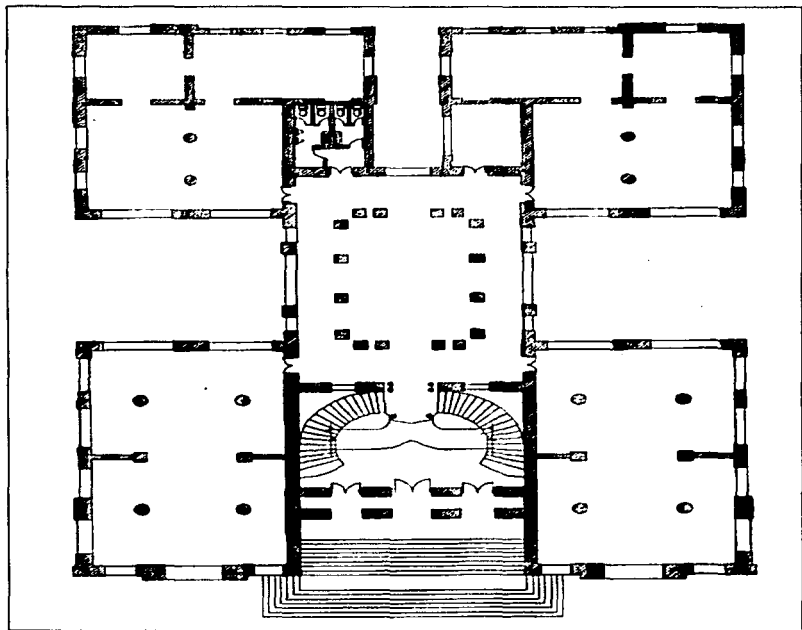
(02) Planta baja del Instituto Nacional de Geología
